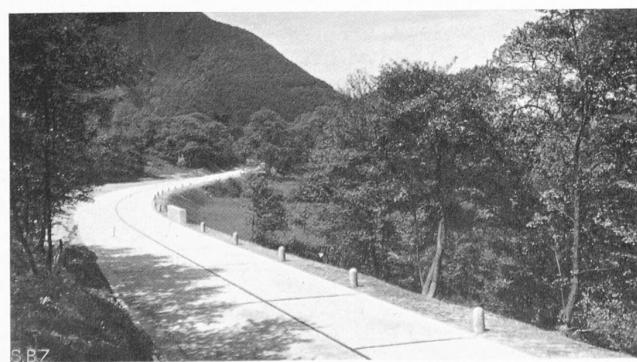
Betonstrasse Ceneri Nordrampe, nahe der Passhöhe.
